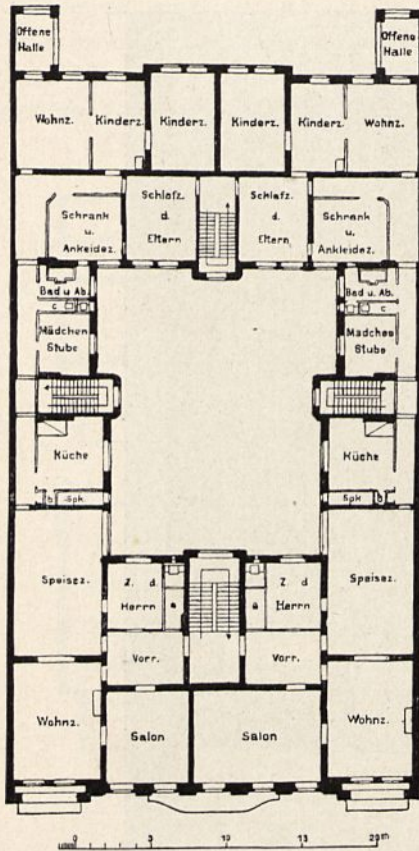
Wohnhaus Tauenzienstraße 14 in Berlin. Grundriß.
